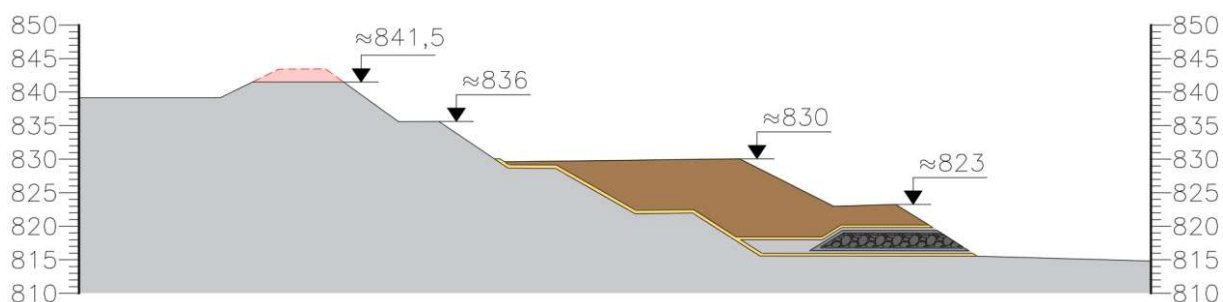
Seção Tipo da escavação do alteamento de montante da Barragem B1
